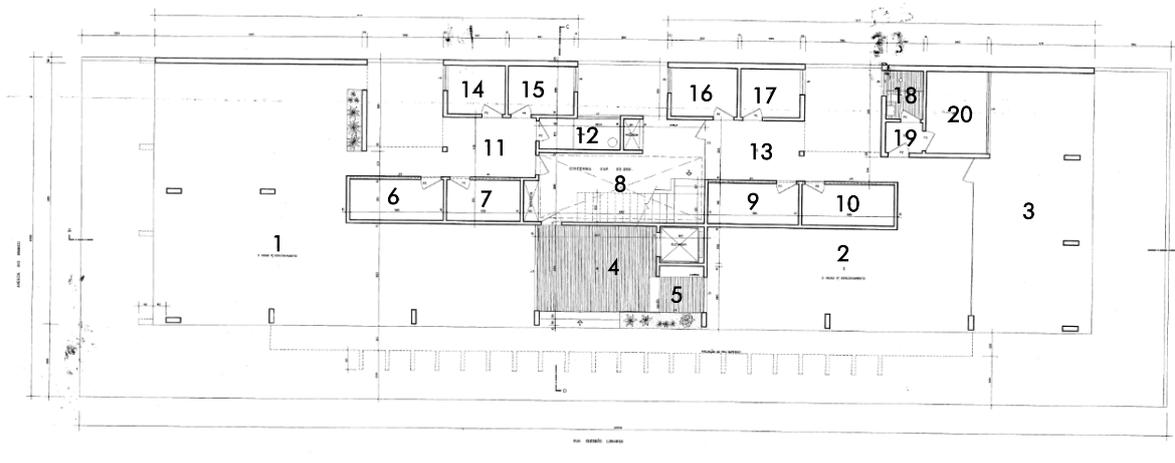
Planta baixa do pavimento térreo, destacando-se o núcleo central de circulação e os ambientes de serviço dispostos simetricamente em torno desse, excetuando-se o bloco administrativo. Programa: 1/2. Estacionamento; 3. Playground; 4. Hall Social; 5. Portaria; 6/7/9/10/14/15/16/17. Depósito; 8. Hall Serviço; 11/13. Área Coberta; 12. Lixeira; 18. Banheiro; 19. Hall. 20. Administração.
